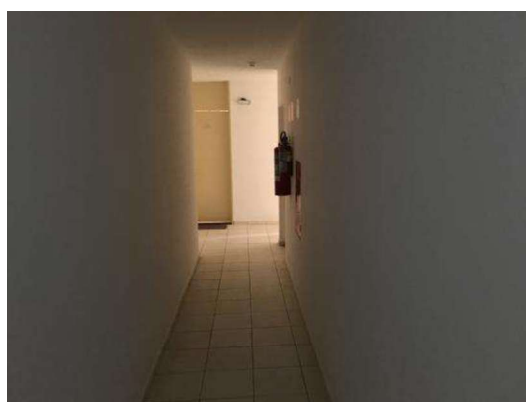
Vista interna – Corredor interno – Edifício Amazonas - Acesso Apto. n°. 33
